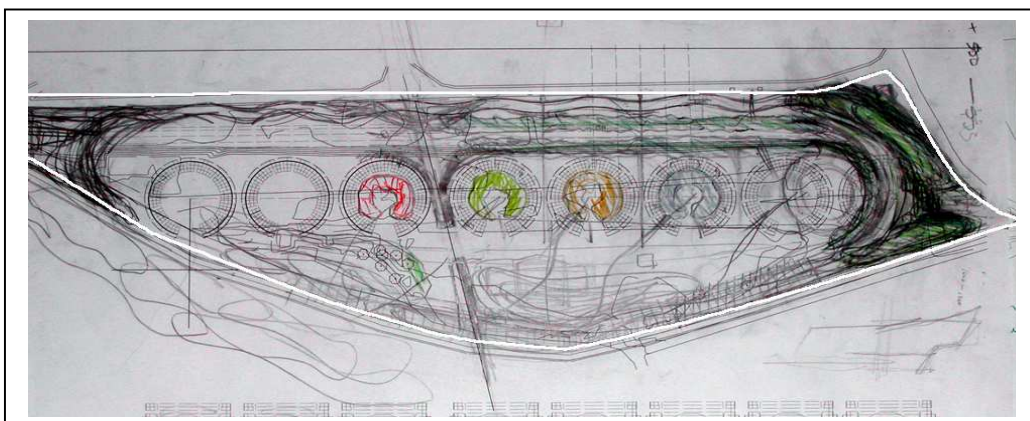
propuesta de construir 8 edificios al centro del predio.
